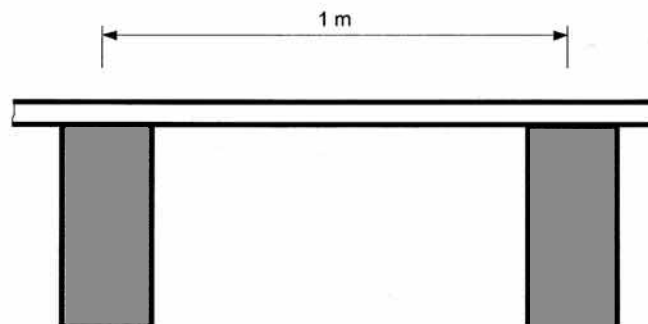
Plancher constitué d'une dalle béton reposant sur des poutres en bois lamellé collé
